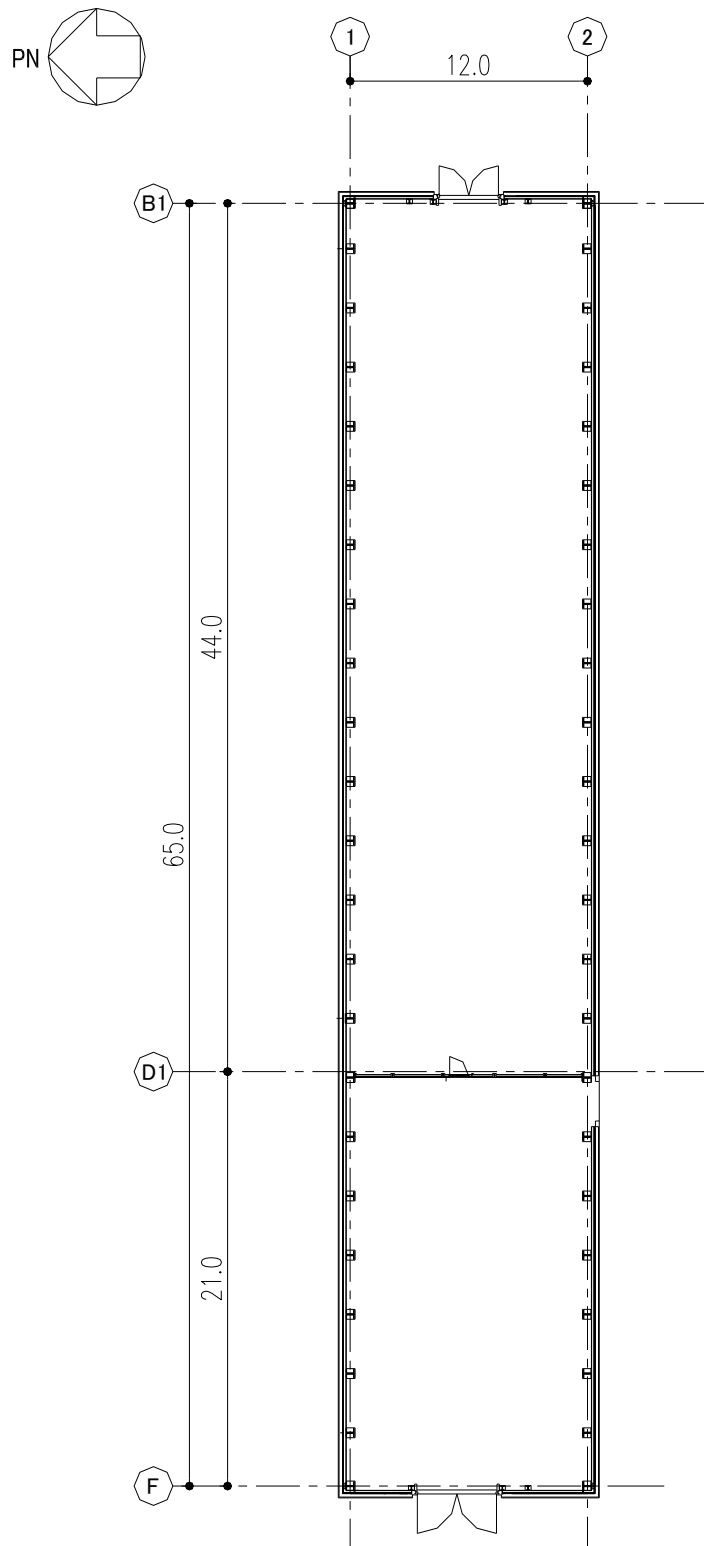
設備棟 建屋平面図 設計 G.L. +0.2 (単位 : m)
